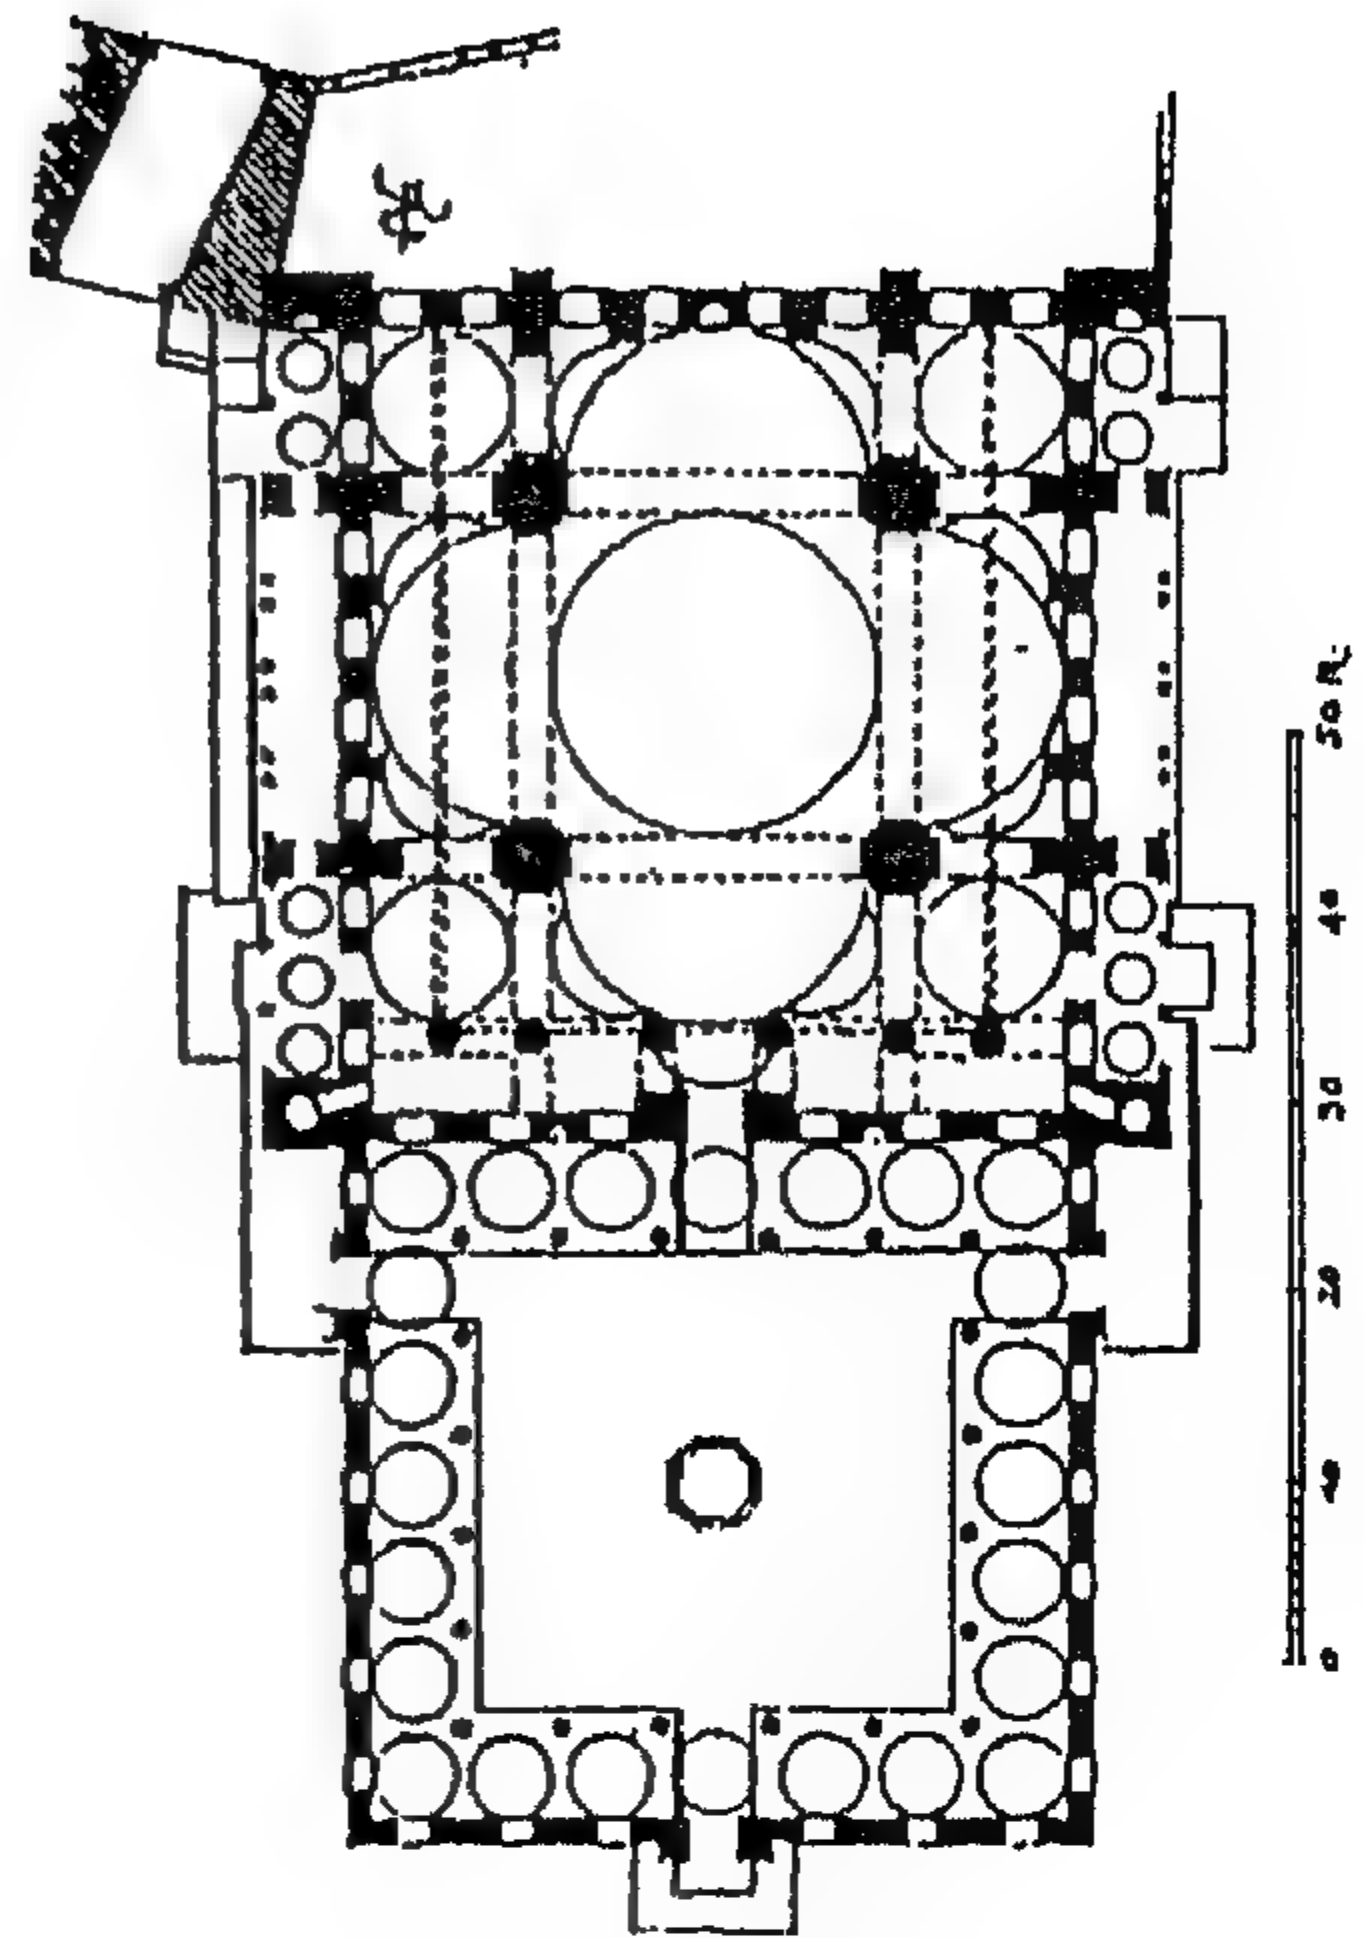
مسقط أفقي لجامع شاهزاده باستانبول - (عن : Goodwin) .
